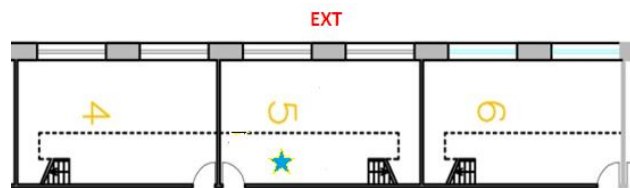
Pianta ufficio 5 – Piano terra. Il posizionamento dei tinytag è indicato dalla stellina celeste.
